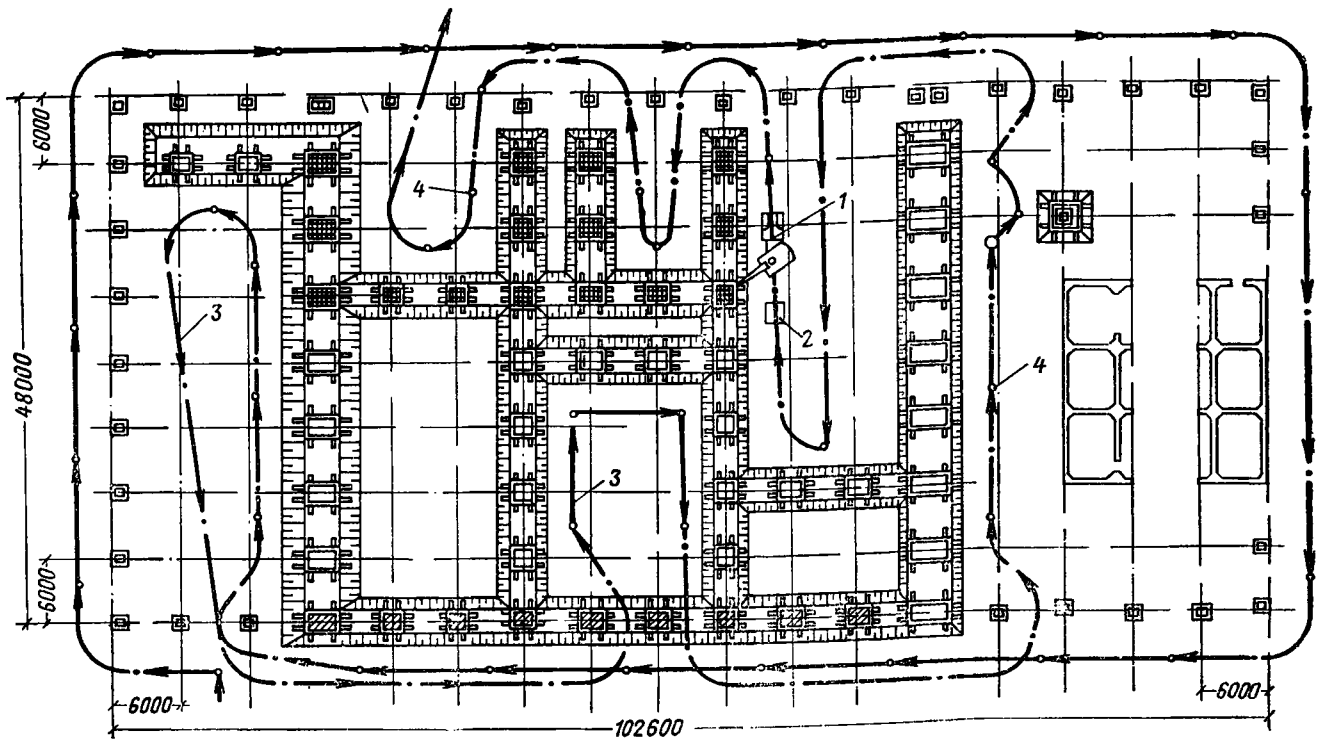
Схема бетонирования фундаментов здания блока вспомогательного ствола:
